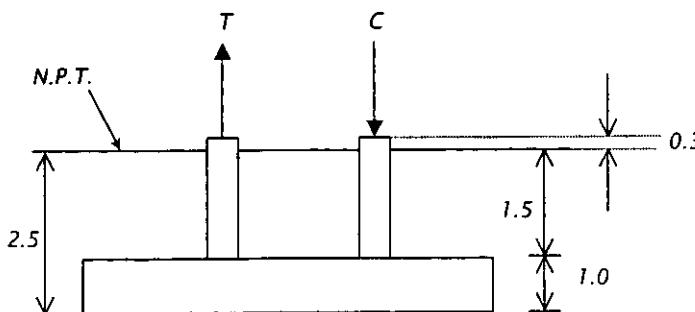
10. Losa en elevación (Unidades en metros).
